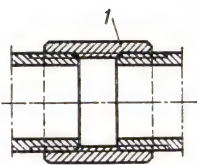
Резьбовое соединение: 1 — резьбовая муфта.
